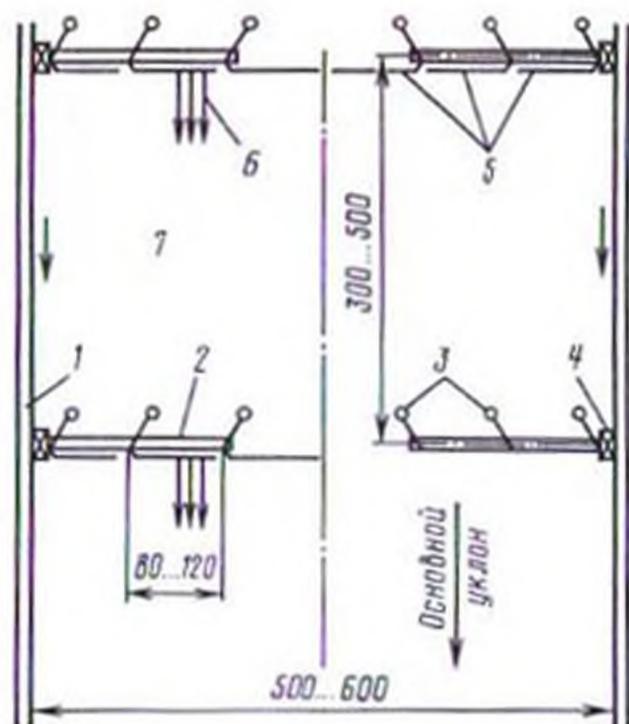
Схема оросительной сети с применением гибких трубопроводов (продольная схема, $i = 0,03...0,07$):
